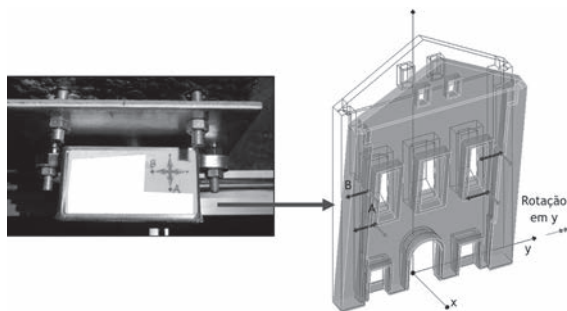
Medição de rotações: (a) Clinómetro instalado e (b) Esquema de posicionamento numa parede
